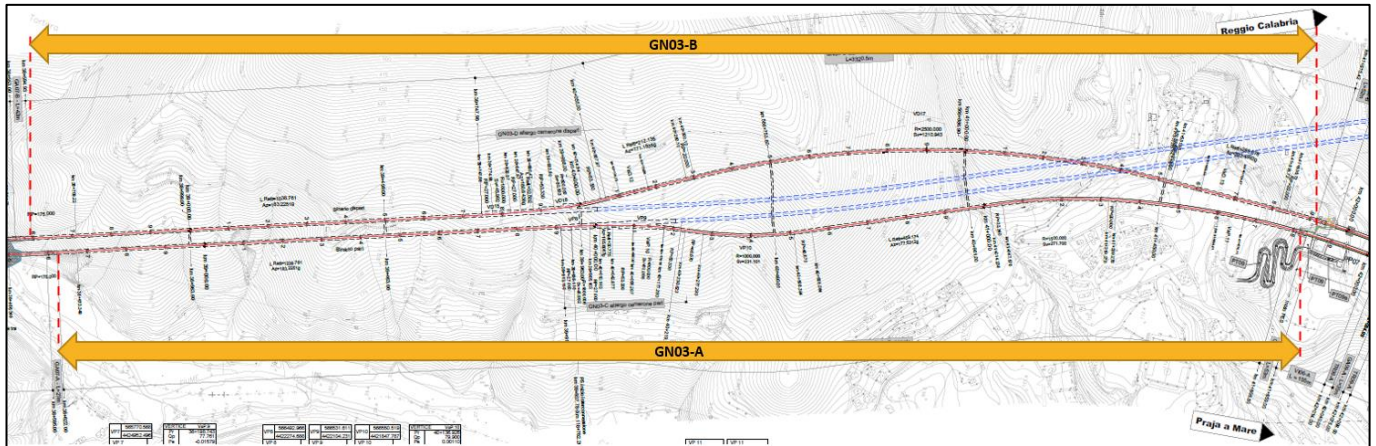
Planimetria di progetto gallerie GN03-A/B da km 38+595 al km 41+859 BP
